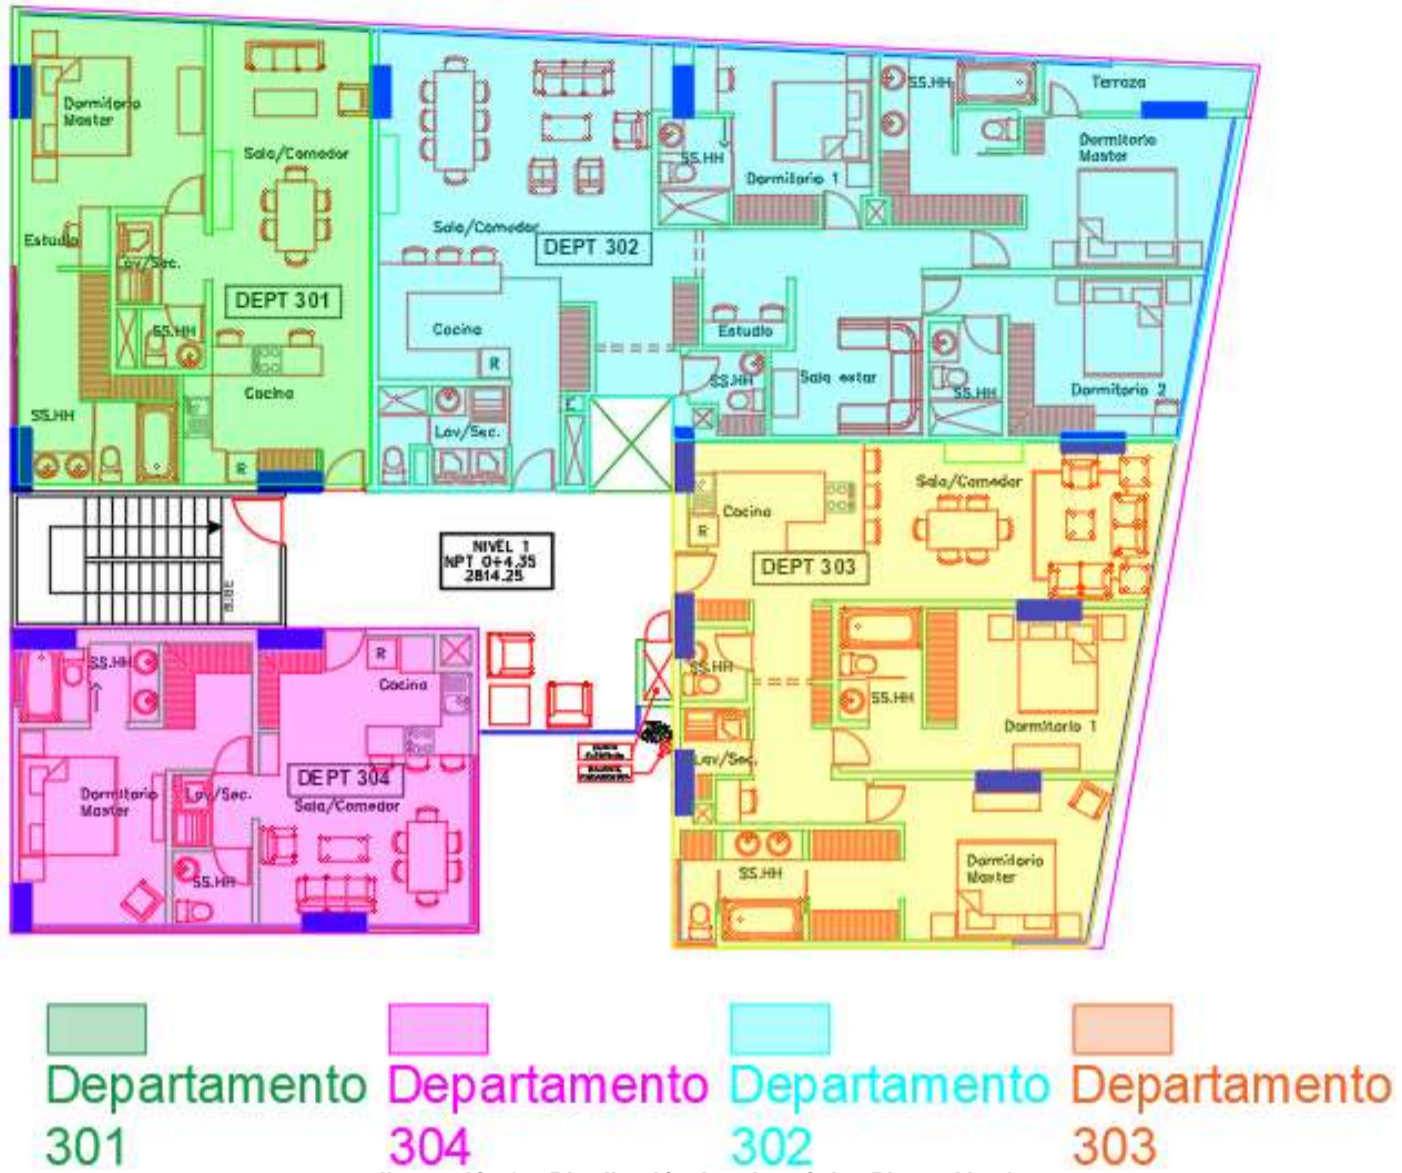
Distribución Arquitectónica Planta Alta 1
